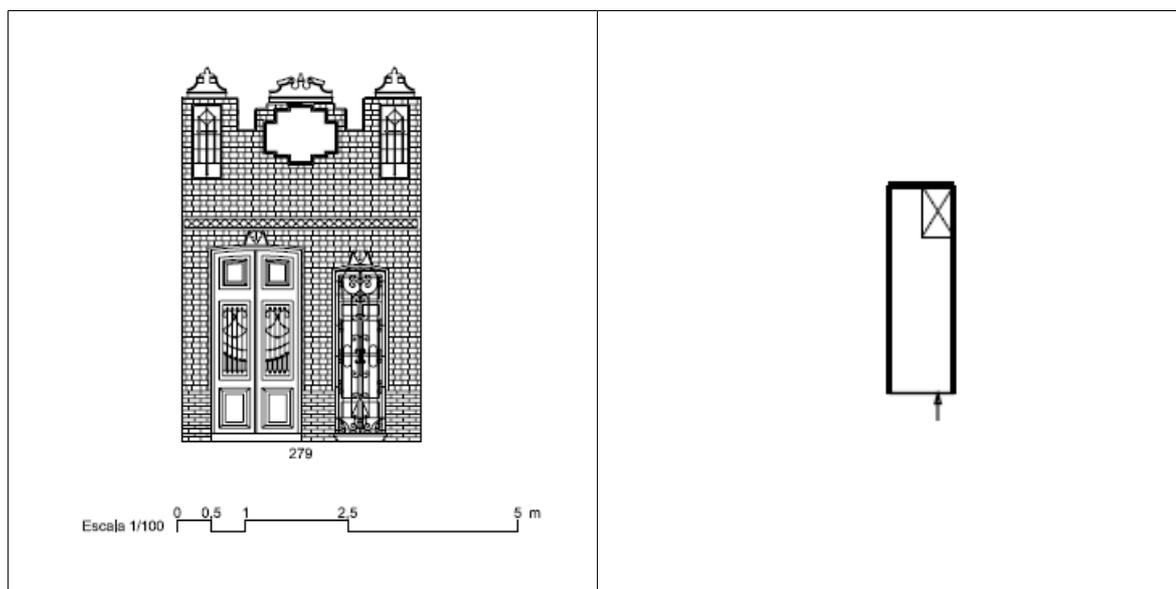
Tipo A11. Ejemplo de fachada y esquema de planta (ficha 213-14)
